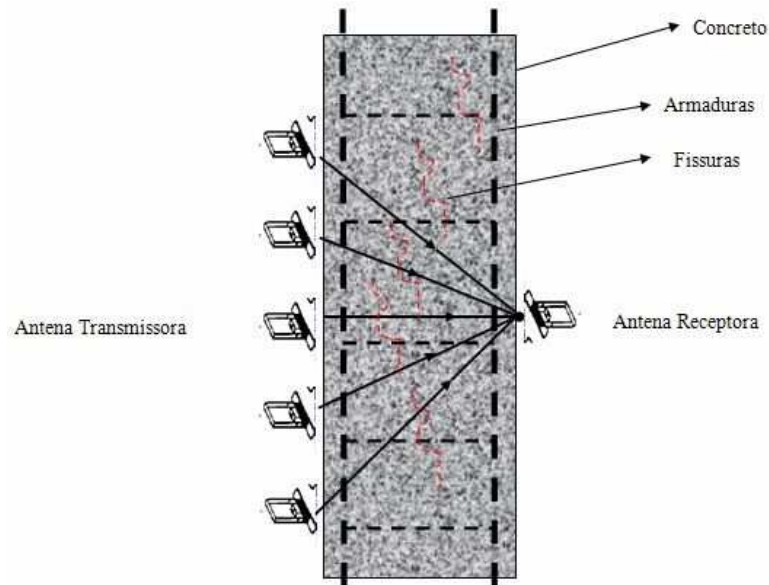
Transiluminação aplicada a uma peça de concreto armado fissurada. Fonte (LOPES, 2009).
